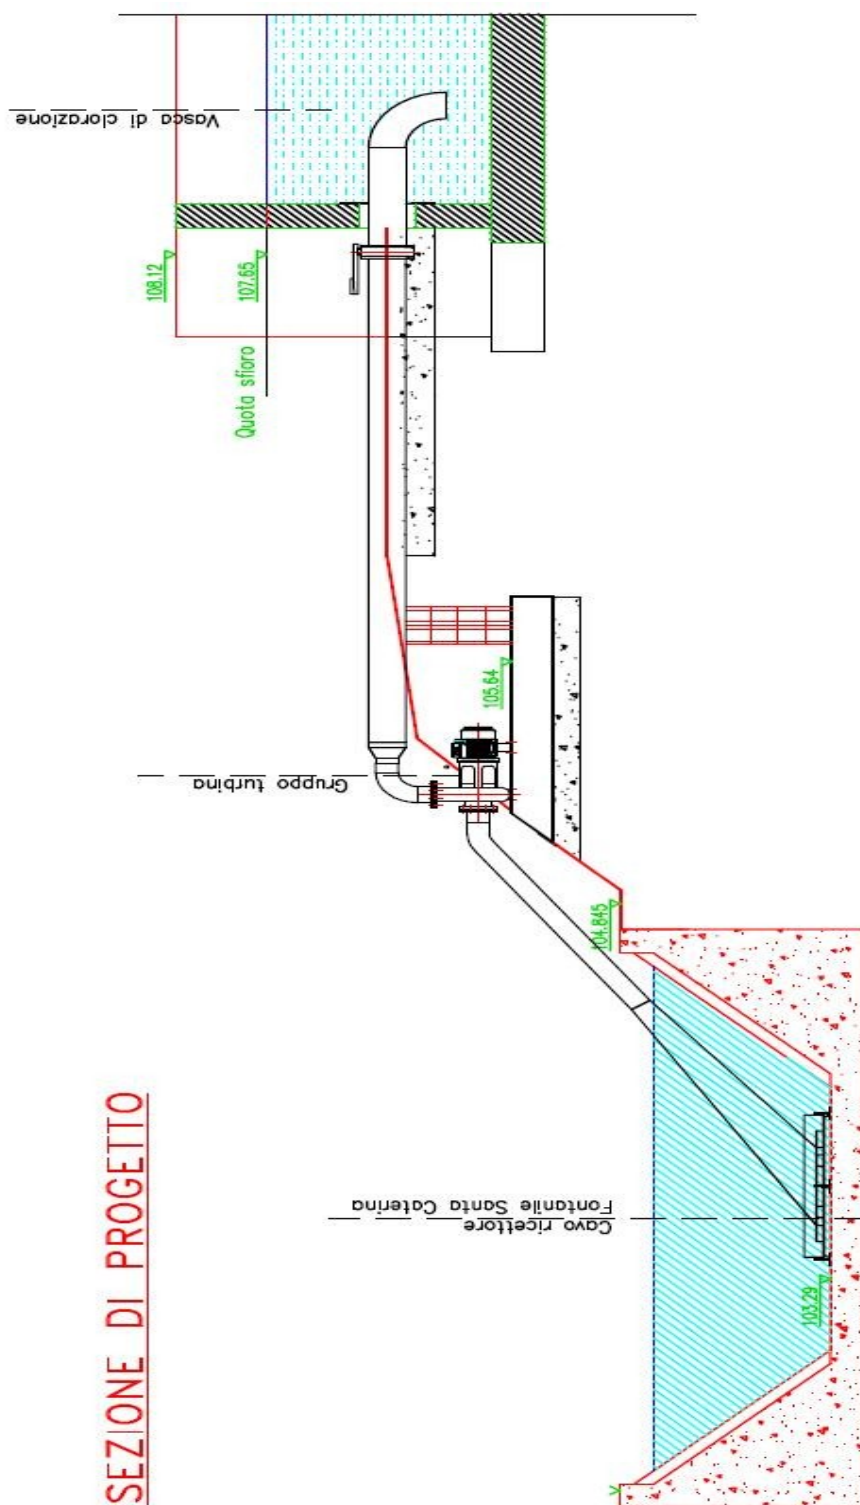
Sezione di progetto del micro-impianto idroelettrico installato a Mortara
